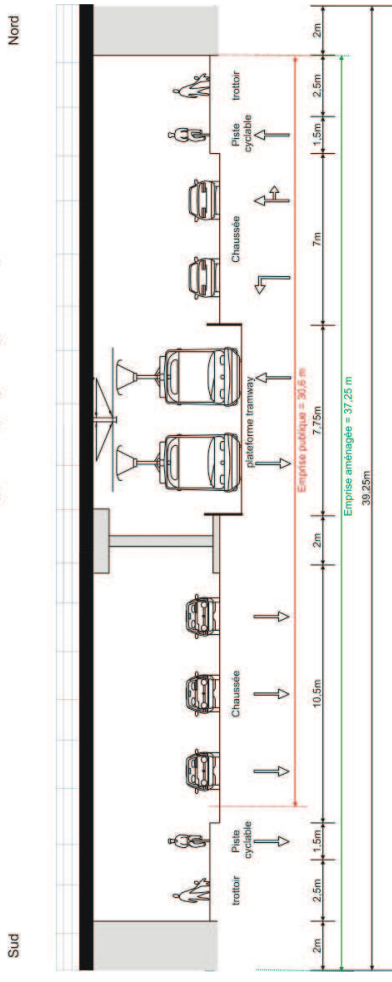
Situation projetée coupe 33 sur la rue de Koenigshoffen
